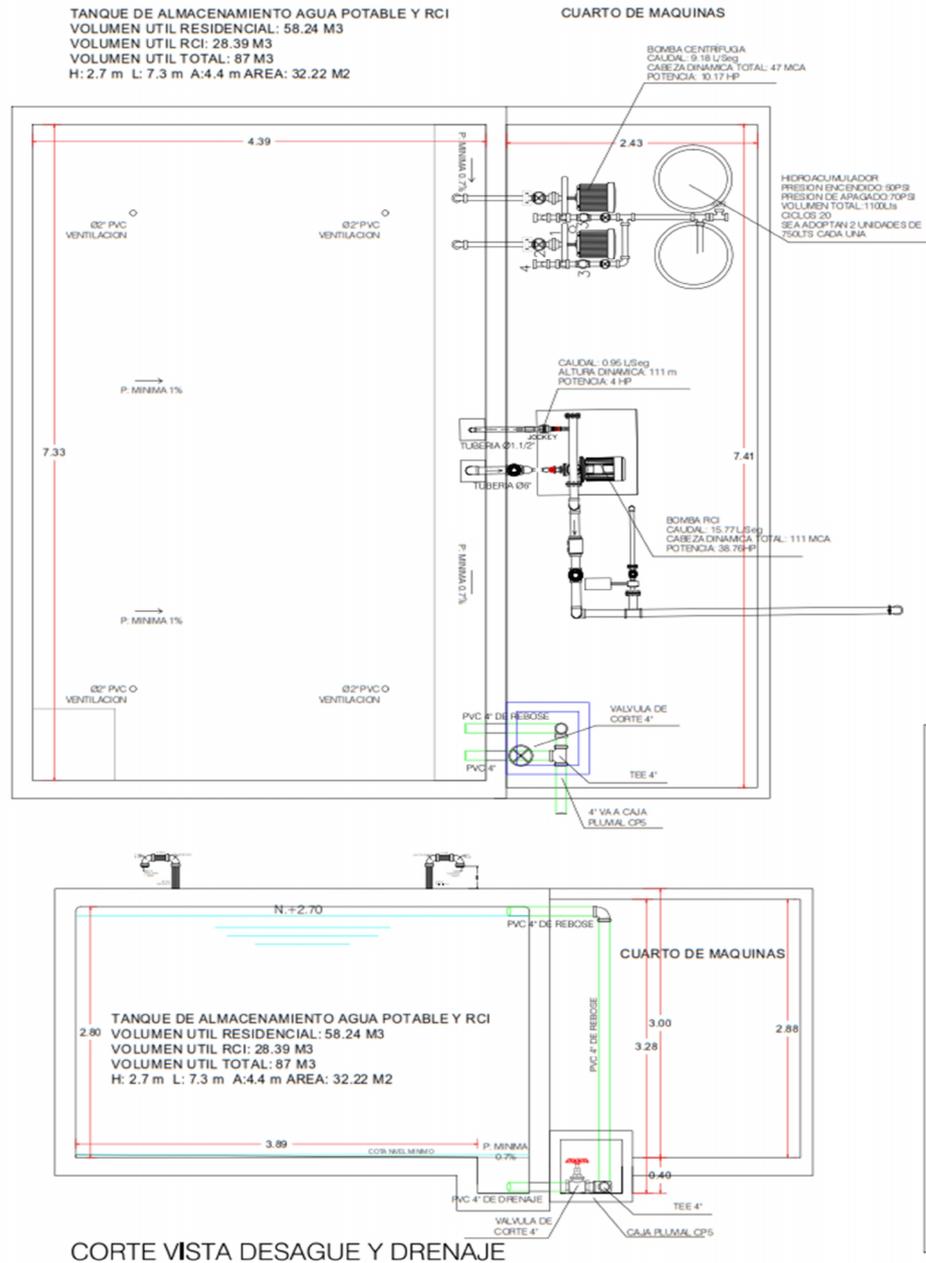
Fuente Plano PLUVIAL SANITARIO 11/11 Juan Felipe Agudelo Patiño
